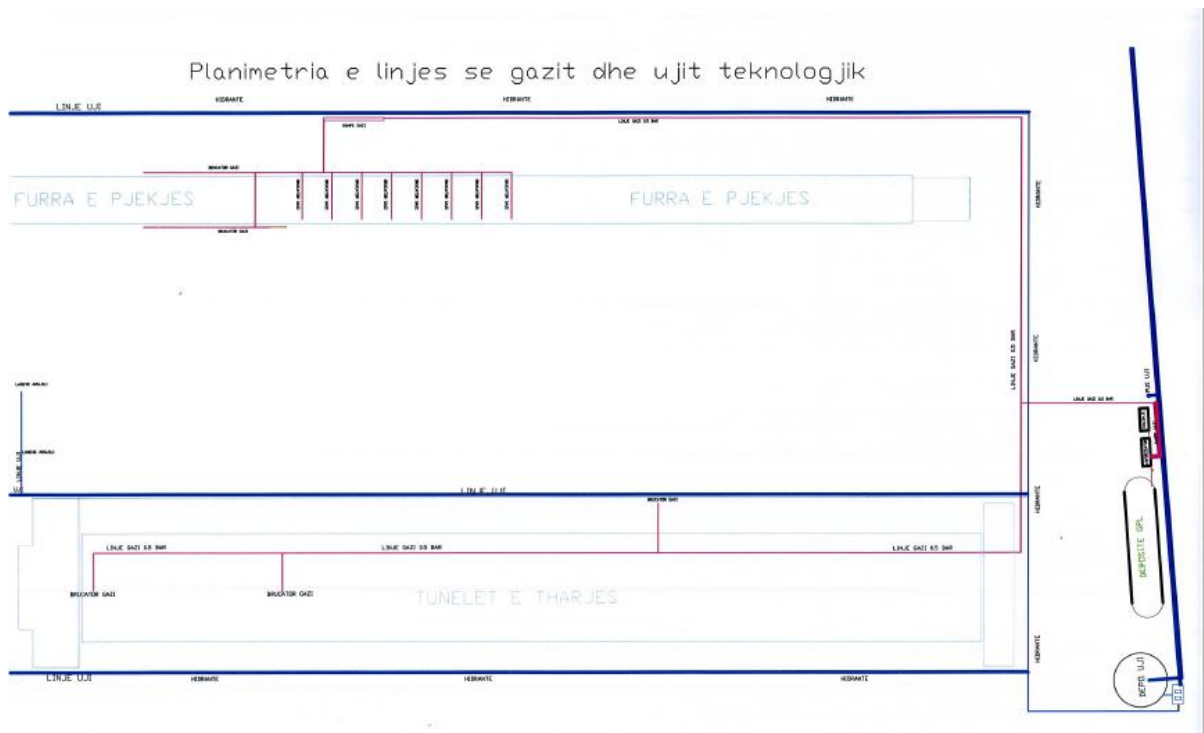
Planimetria e linjes se gazit dhe ujit teknologjik
